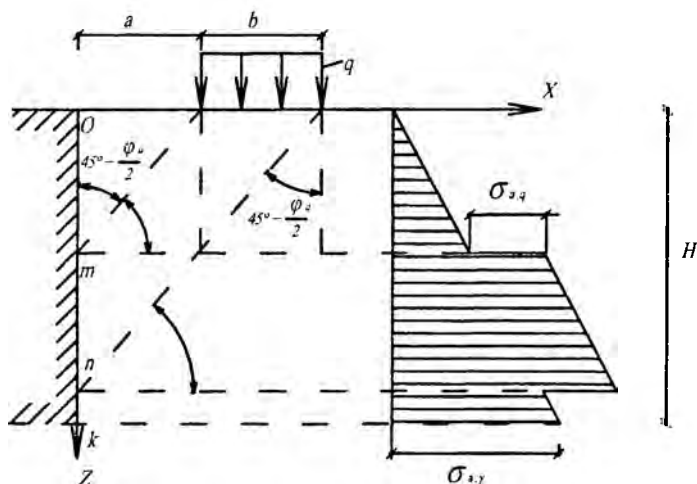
Расчетная схема для определения активного давления на подпорную стенку от полосовой нагрузки
